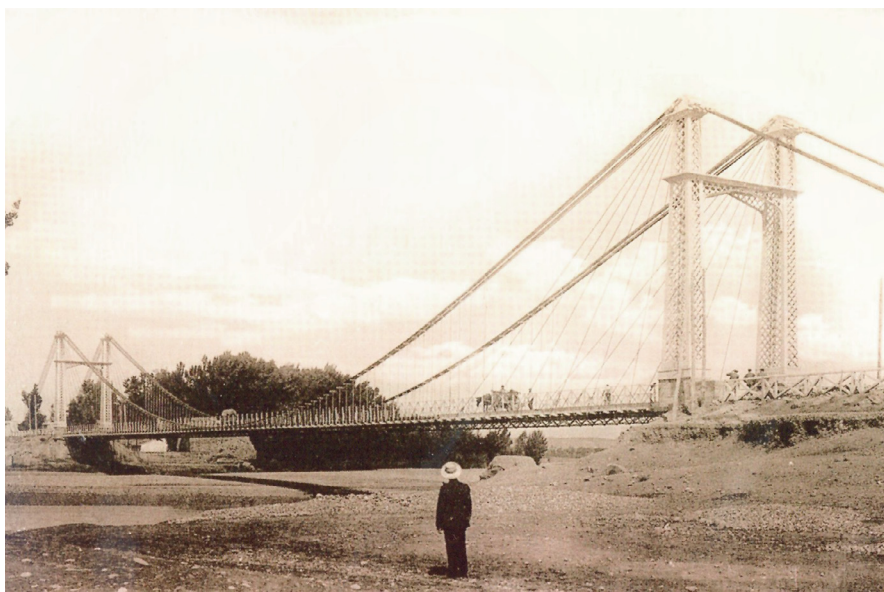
Puente de Santa Isabel sobre el río Gállego, 1864.
